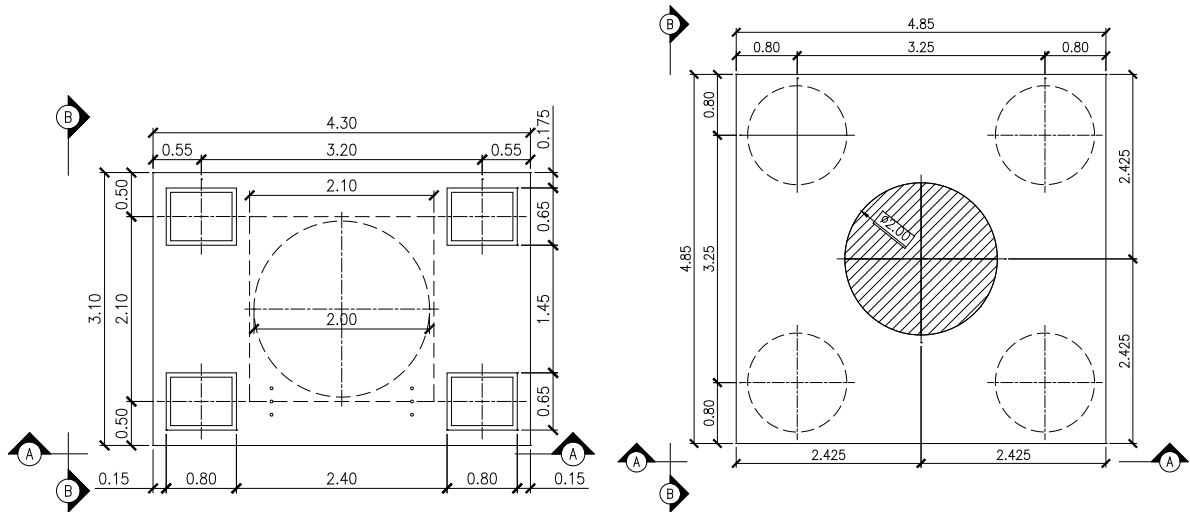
Planta del capitel (izq.) y cabezal de fundación de las pilas.
